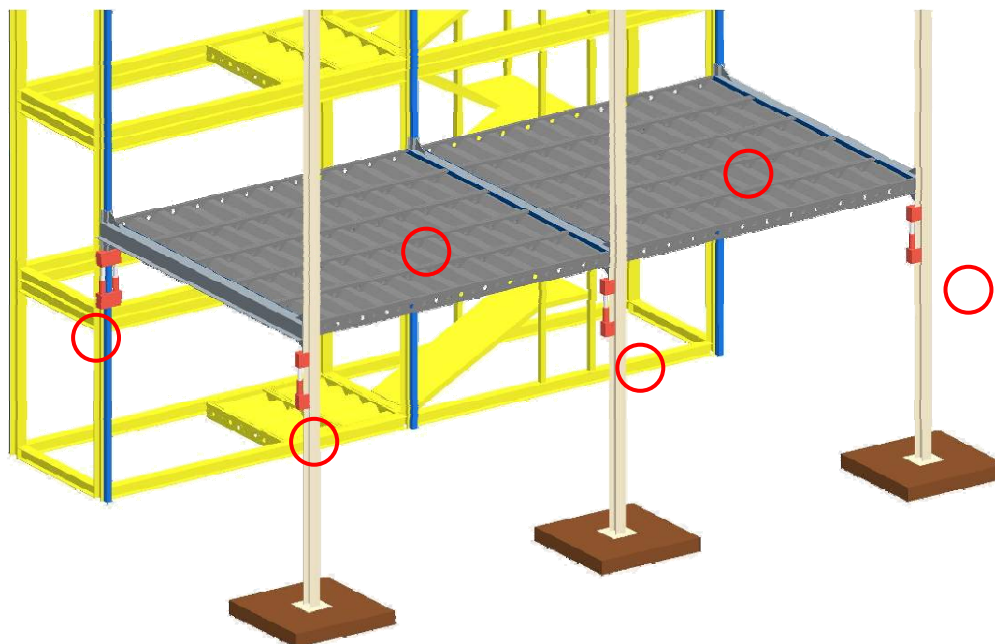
Elevación de la planta con un núcleo de doce metros de largo
